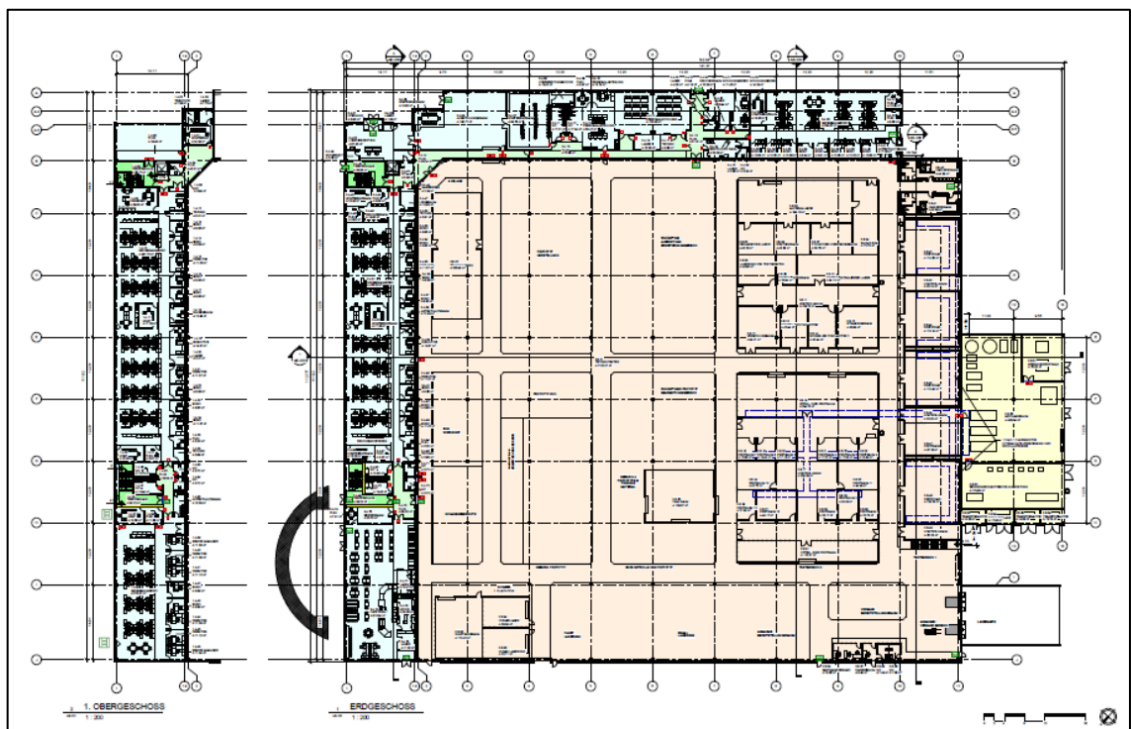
Grundrissübersicht (Darstellung unverbindlich) (Quelle: SSOE Group / Scalaplan GmbH, Stand 17.06.2019)
